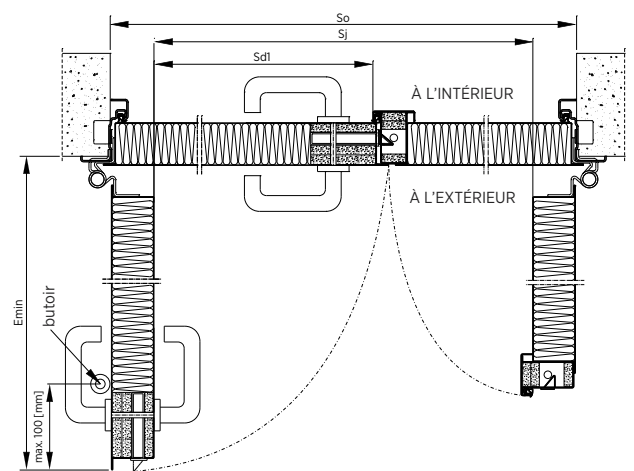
Pose au bâti angulaire d'un bloc-porte à deux battants - coupe horizontale
